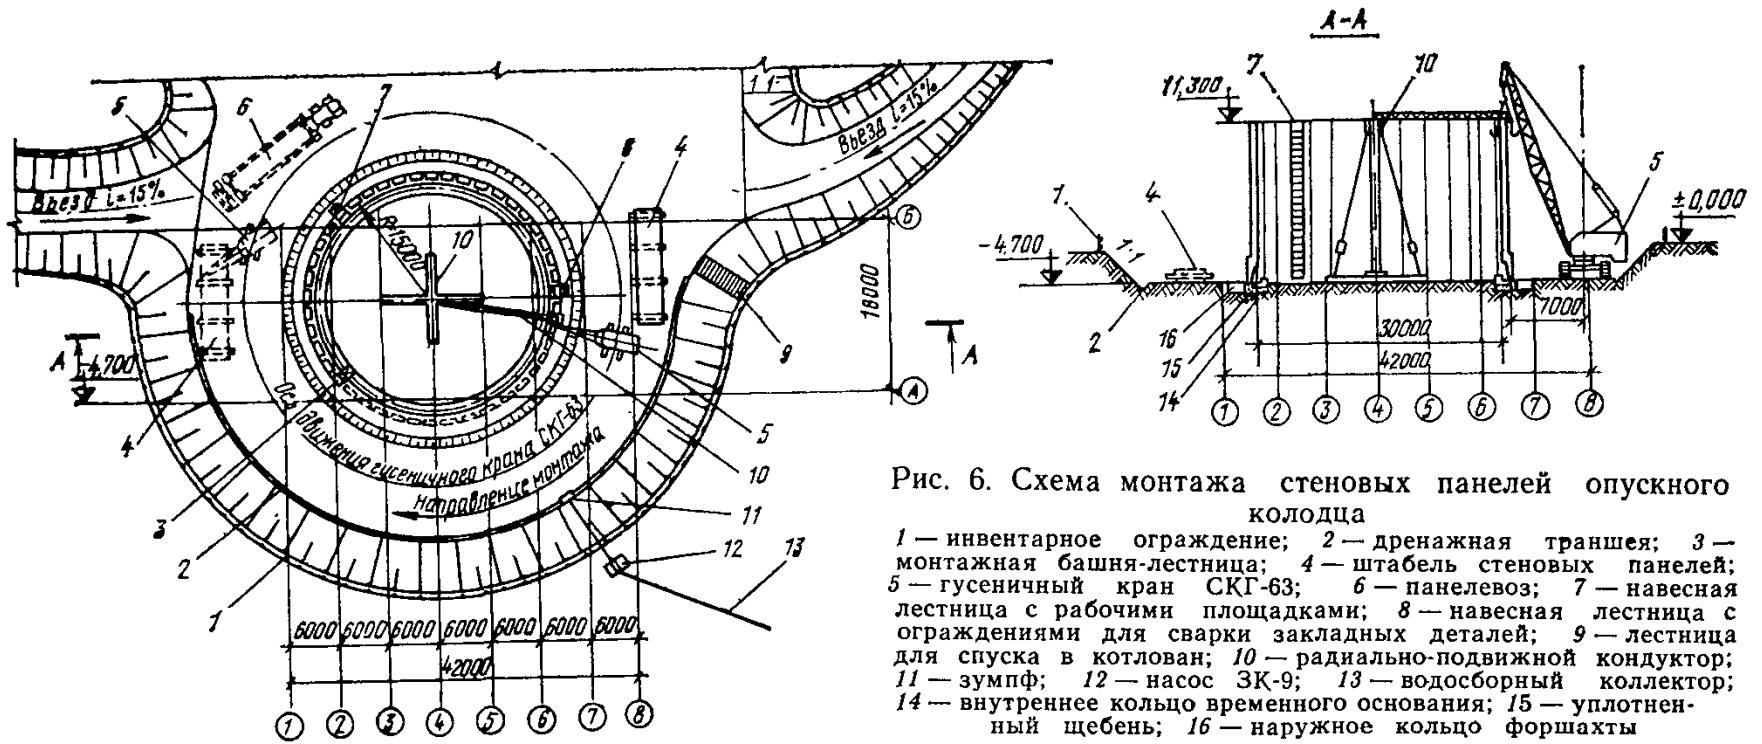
Схема монтажа стеновых панелей опускного колодца
